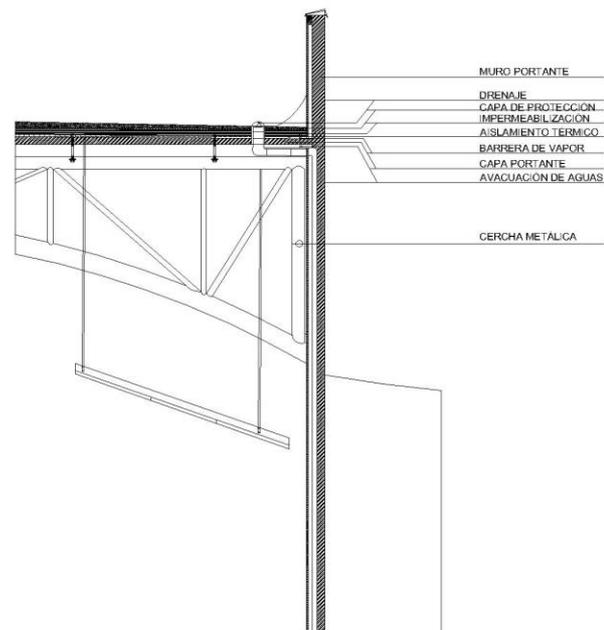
Detalle constructivo Teatro de la Sinfónica infantil. Elaboración propia.
